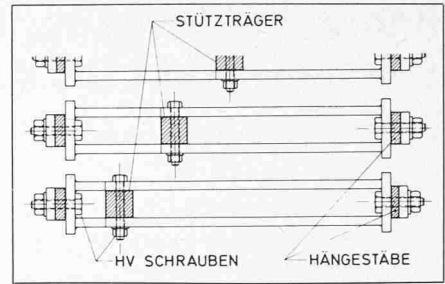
Grundriss unten bei Fahrbahnübergang, Koppelfuge
